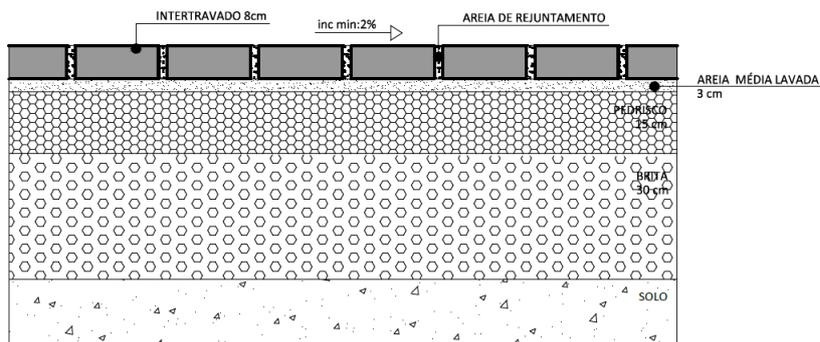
Esquema do pavimento em blocos de concreto intertravados
